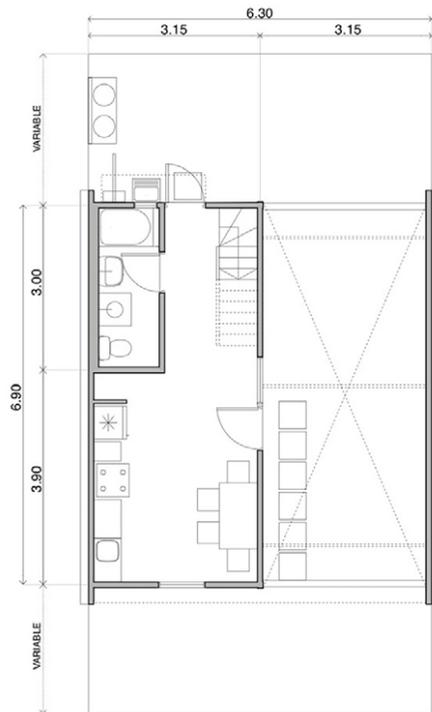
Planta Baja INICIAL Villa Verde.
